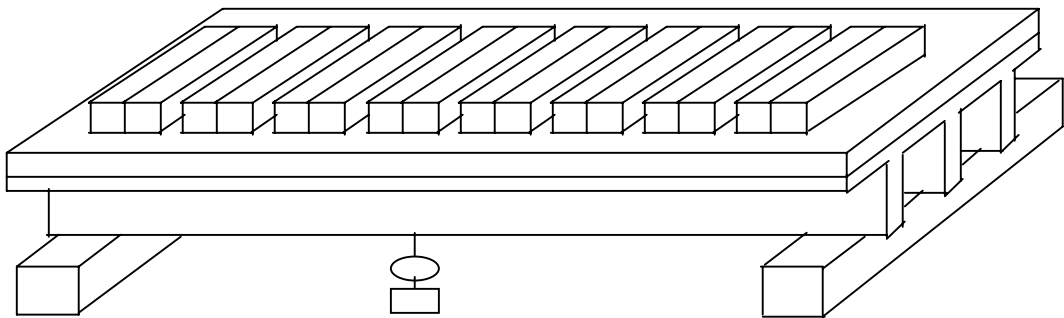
Ensayo de Losa de Ferrocemento
